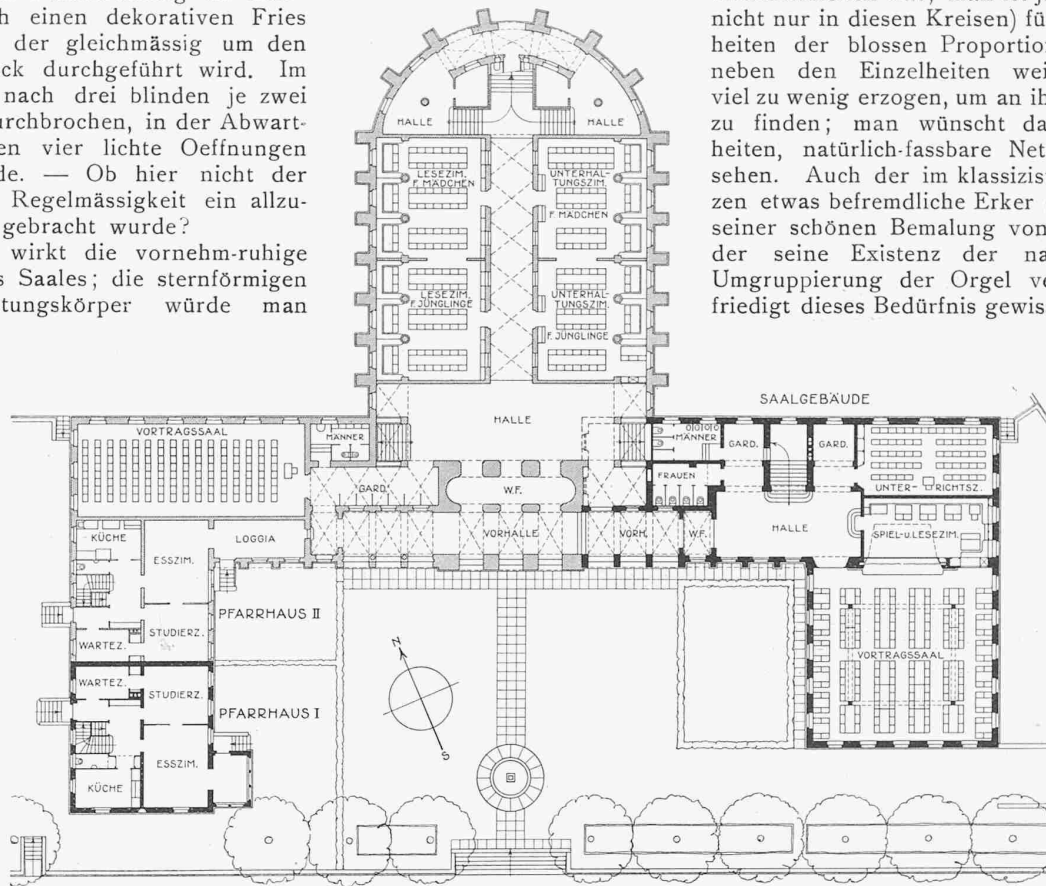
Grundriss vom Erdgeschoss, schwarz ausgeführt, schraffiert spätere Erweiterung. — Masstab 1:500.
